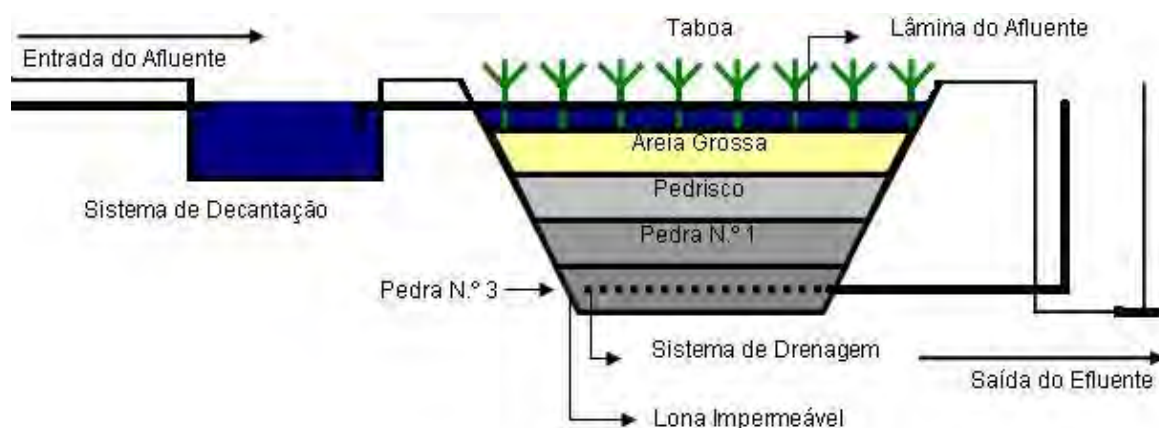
Desenho esquemático do primeiro sistema de alagados construídos com plantas emergentes com fluxo vertical.
